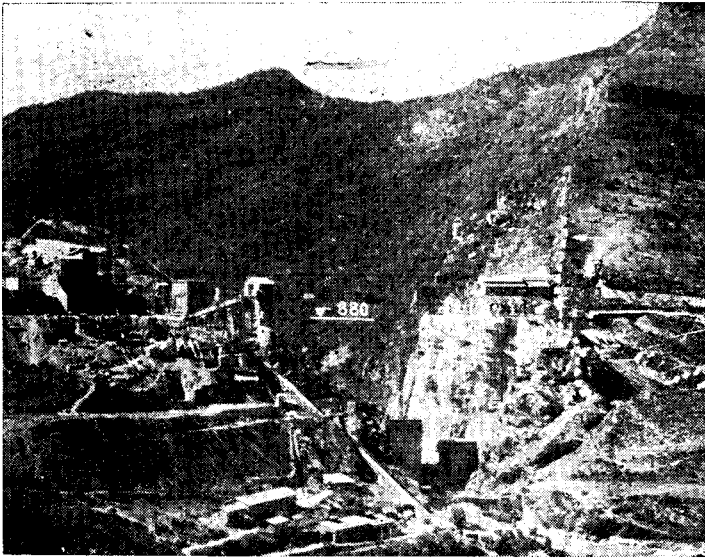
Vue de l'emplacement du barrage de Castillon; en pointillé, la "cassure au large".
